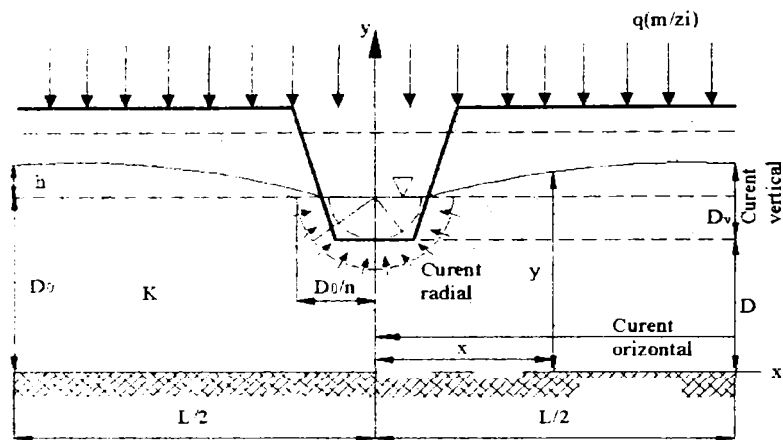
Elementele de calcul ale drenajului considerându-se un canal deschis
